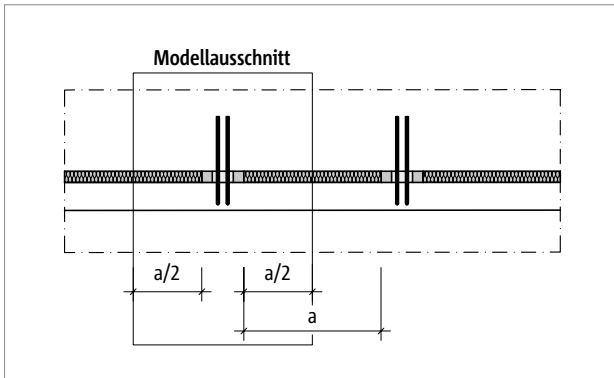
Darstellung eines möglichen Modellausschnitts für eine dreidimensionale Modellierung eines Wandanschlussdetails, mit punktuell platzierten Schöck Sconnex® Typ W und dazwischenliegender Dämmung
